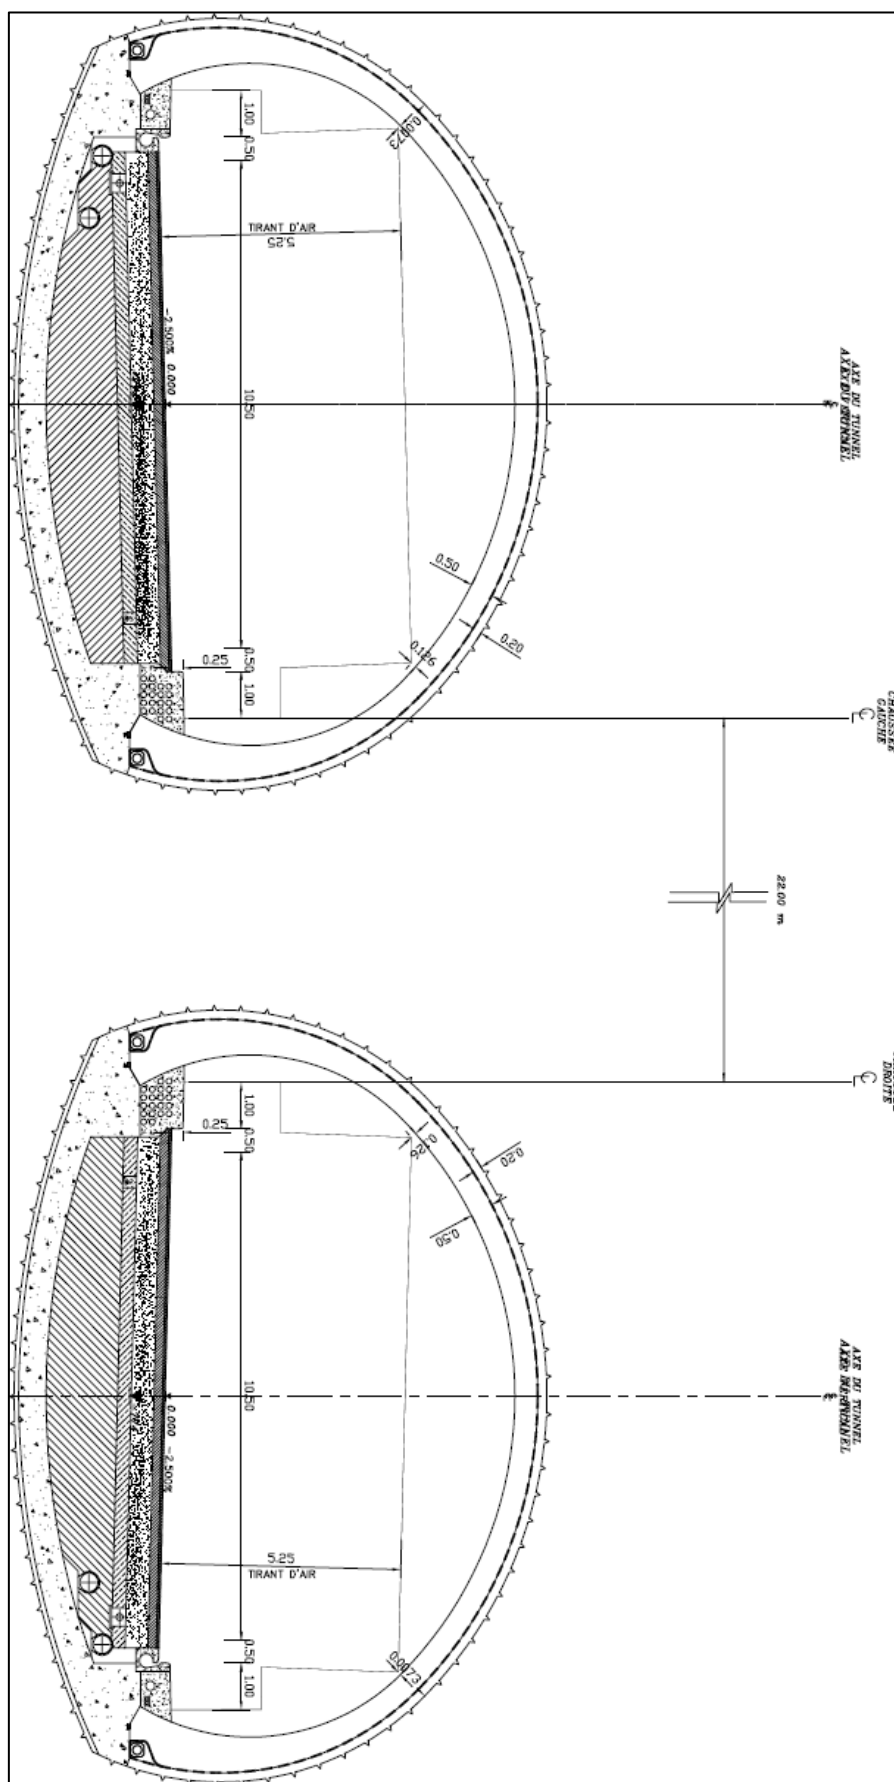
Coupe transversale des deux tubes du tunnel T4
